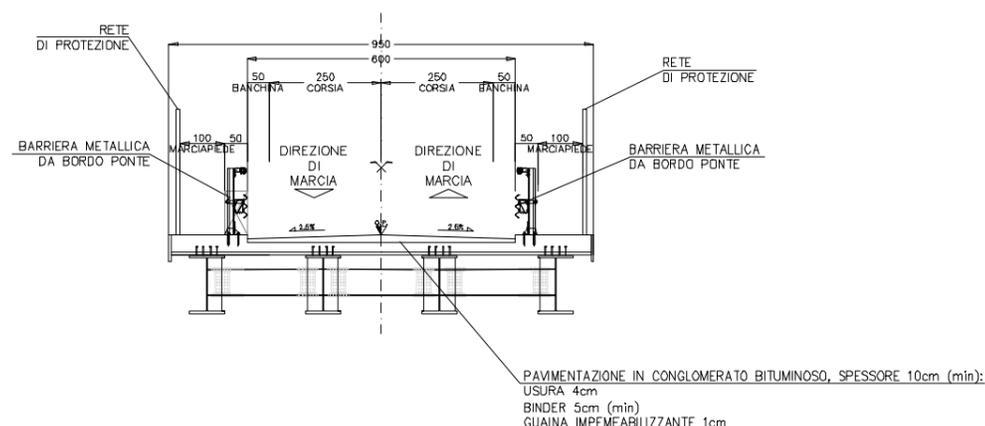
Viabilità interferite, sezione tipologica su impalcato
